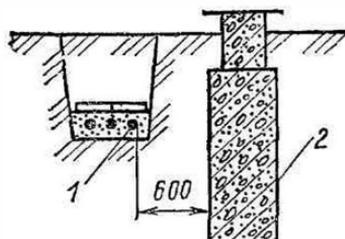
Прокладка кабелей рядом с фундаментом здания и сооружений:
